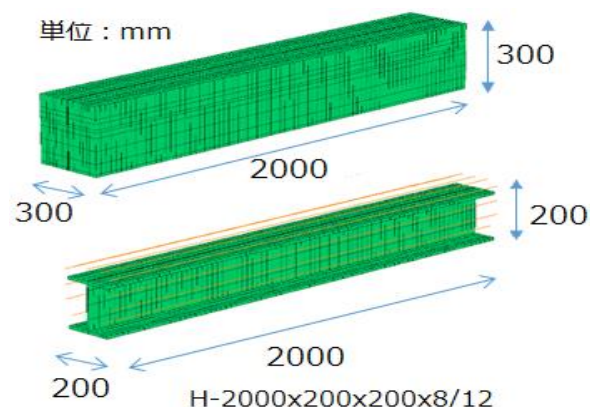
解析モデルの寸法 (コンクリートと鉄骨)
